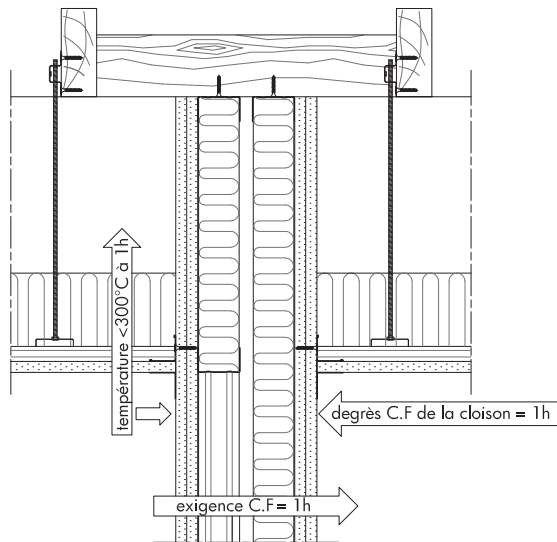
Cloisons fixées sous la structure - ERP type U
